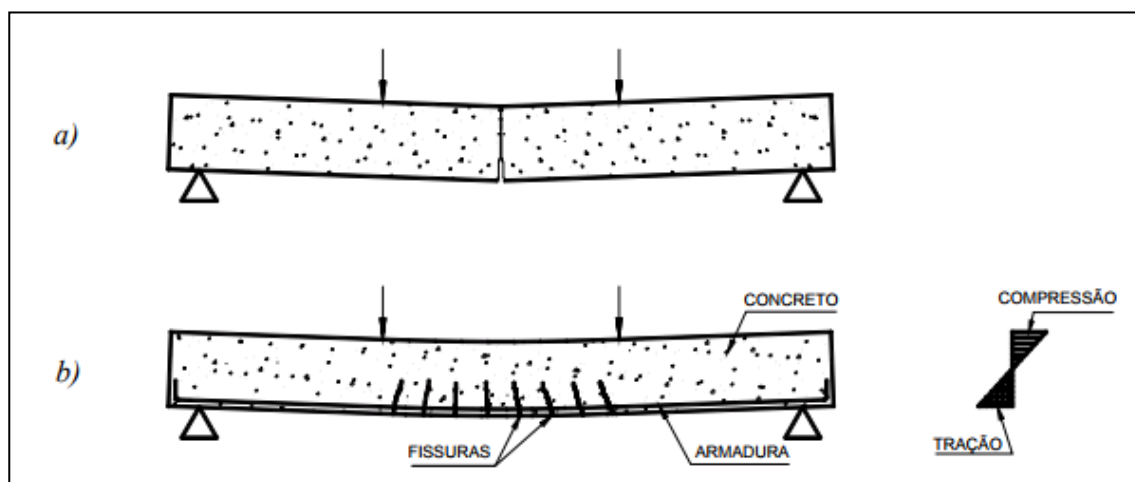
Comparação entre viga de concreto (a) e viga de concreto armado (b).
